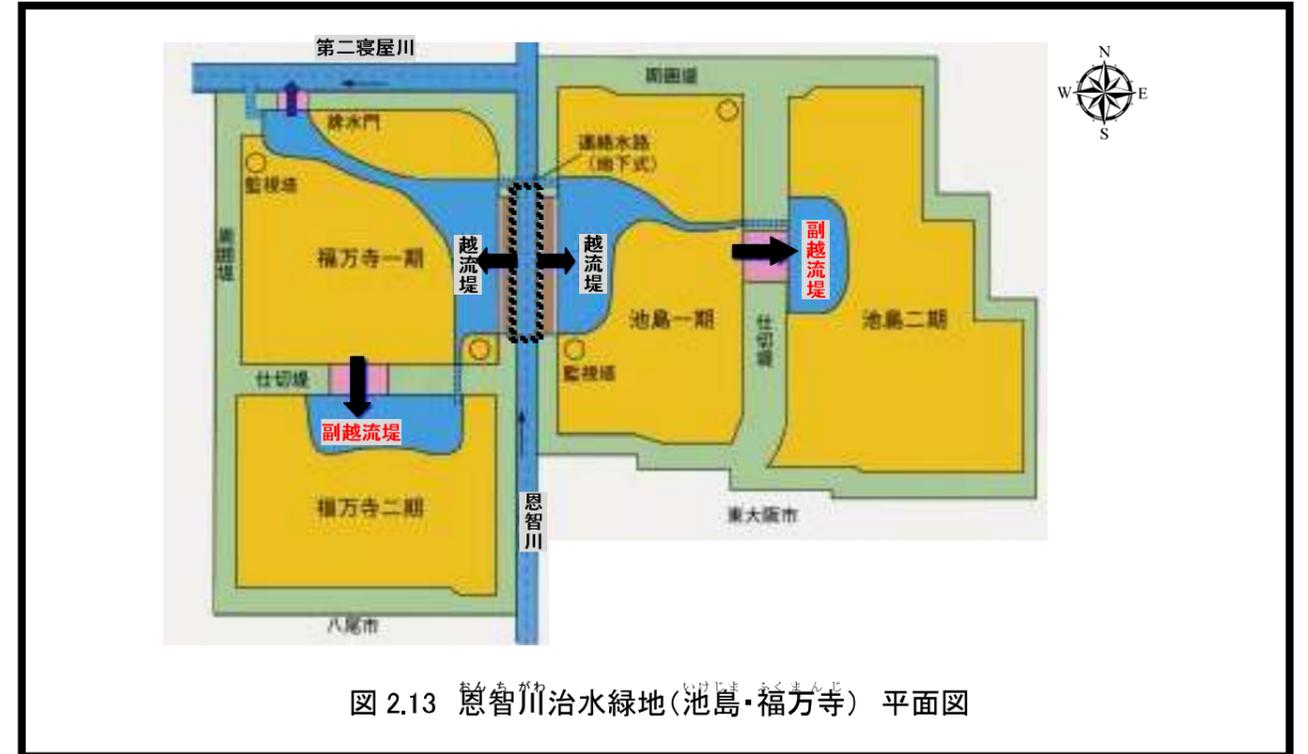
恩智川治水緑地(池島・福万寺) 平面図
